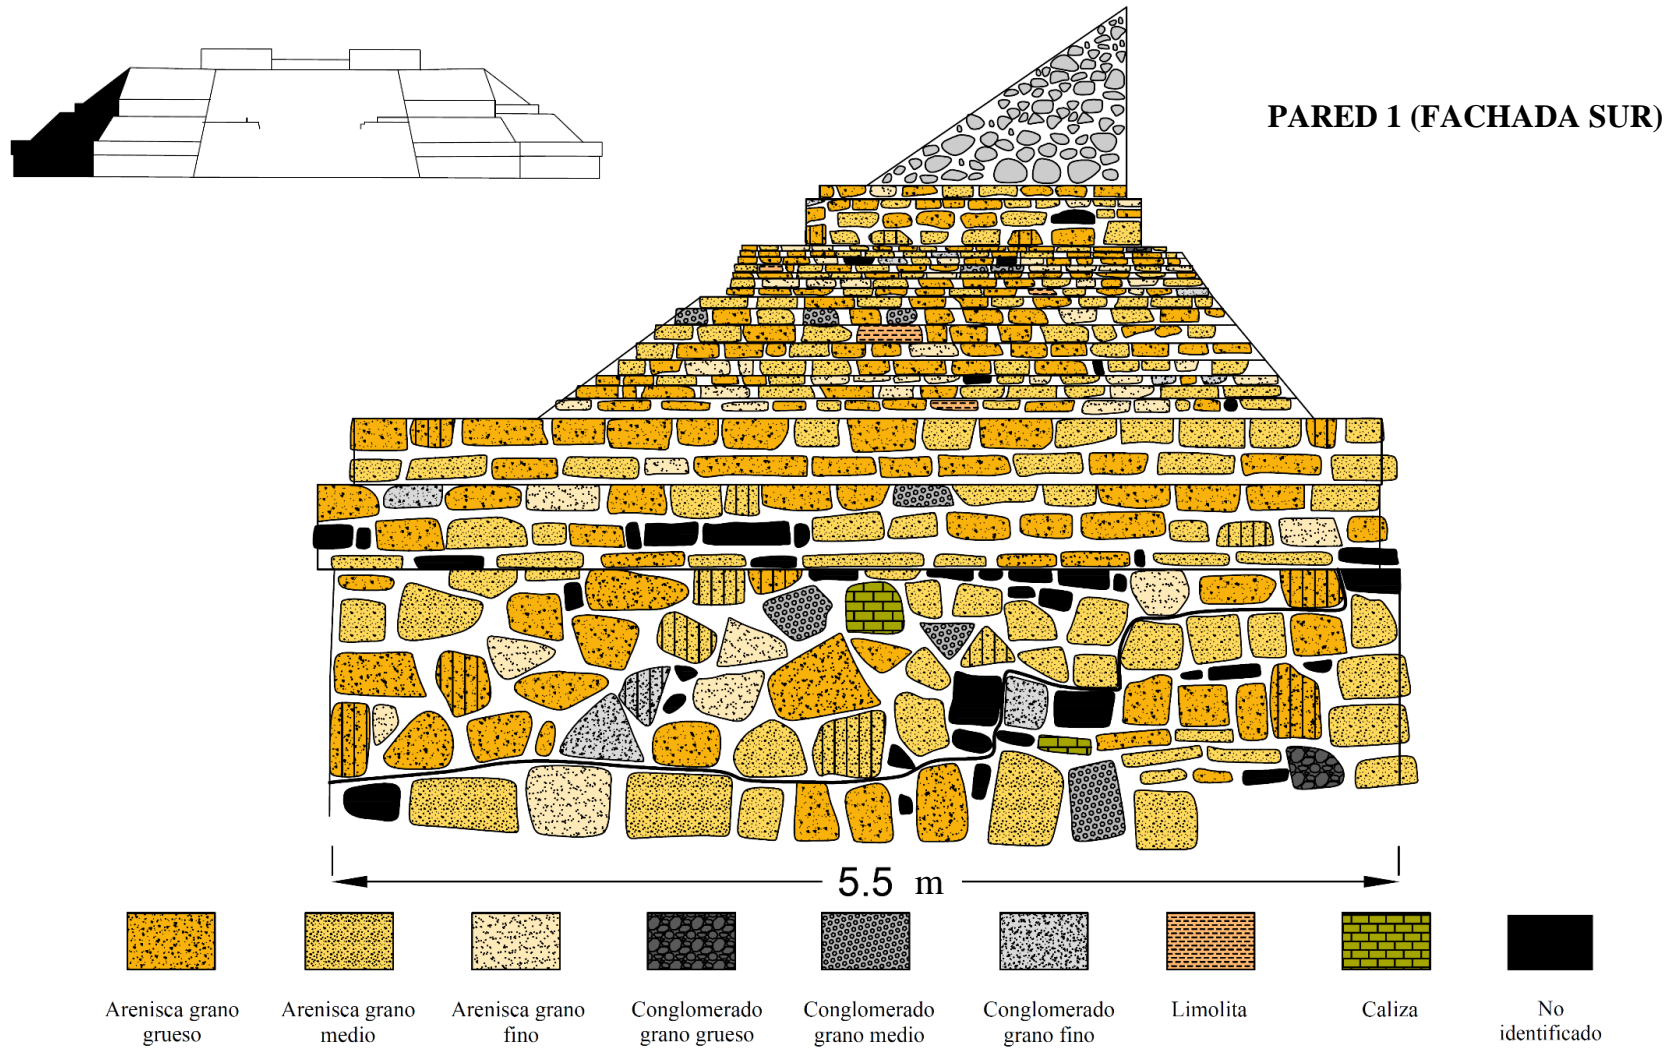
Registro litológico de la pared 1, correspondiente a la Fachada Sur del Edificio D. La línea negra que atraviesa la estructura representa separación de la parte original del inmueble (zona inferior) y la parte que ya ha sido restaurada (zona superior).
